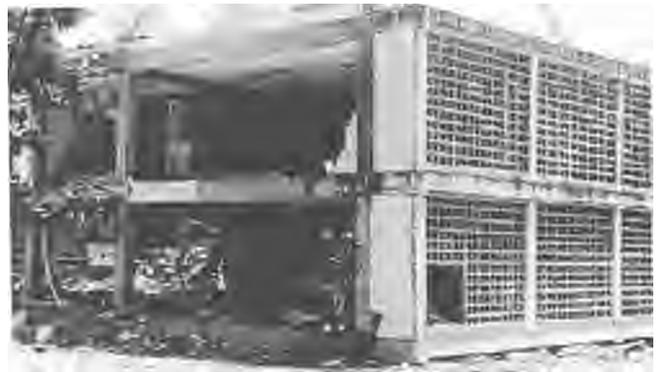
Vista general del colapso del nivel planta baja en el liceo Raimundo Martinez en Caneco
